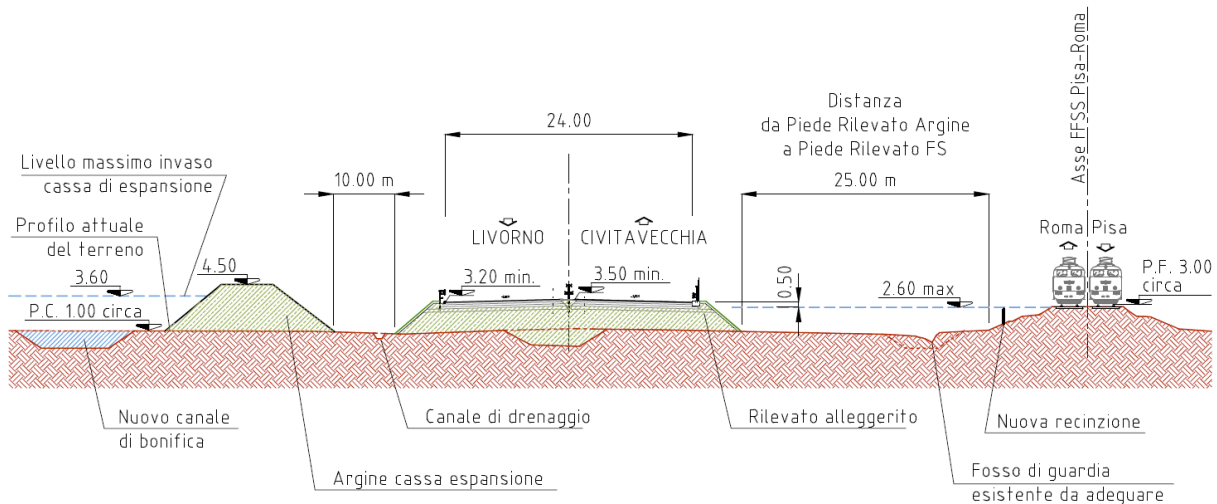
Sezione tipo autostradale nell'area Campo Regio
